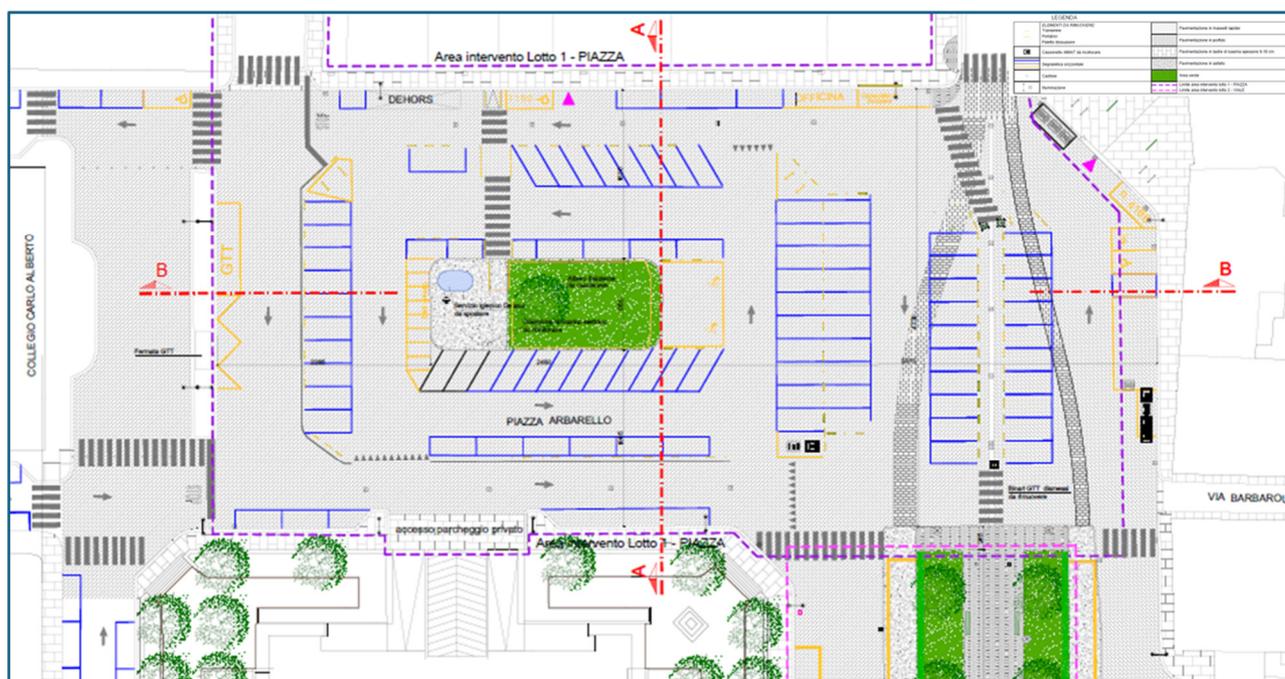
Lotto 1 Piazza Planimetria stato di fatto
